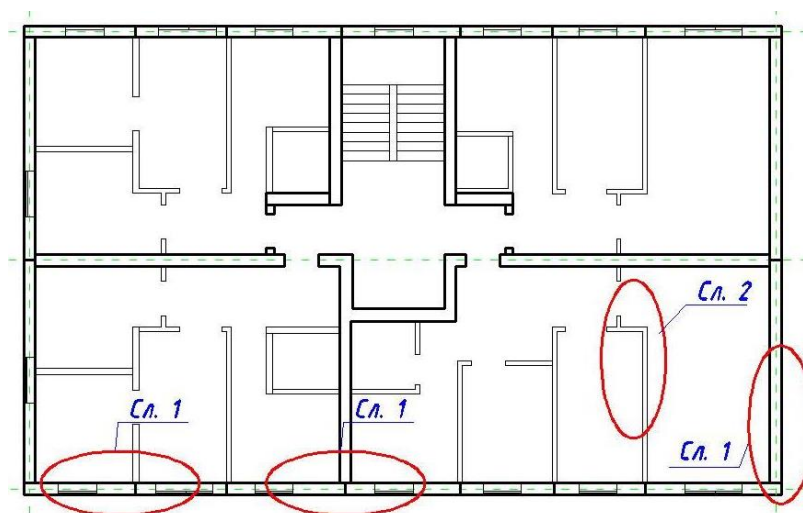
Схема расположения локальных разрушений типового этажа панельного здания
